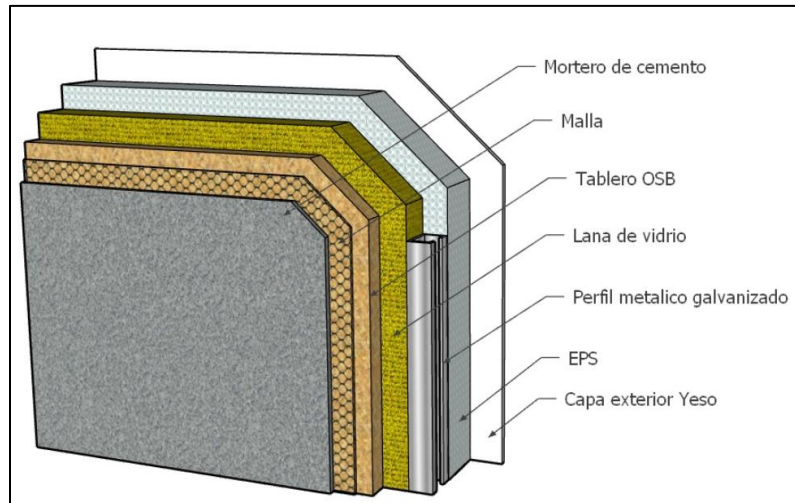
Configuración del paquete constructivo Steel Framing.
